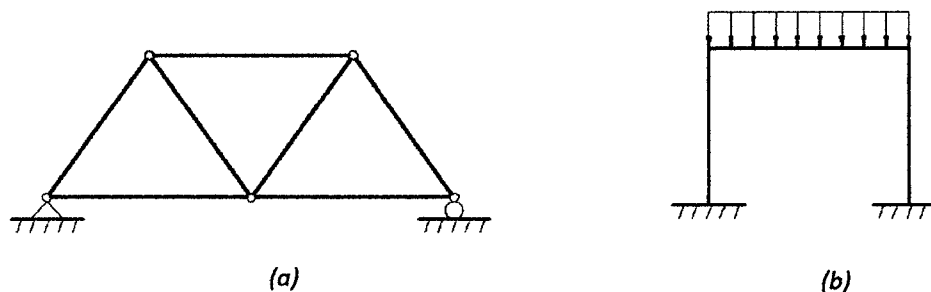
35: (a) Estructura articulada, (b) Estructura reticulada.
